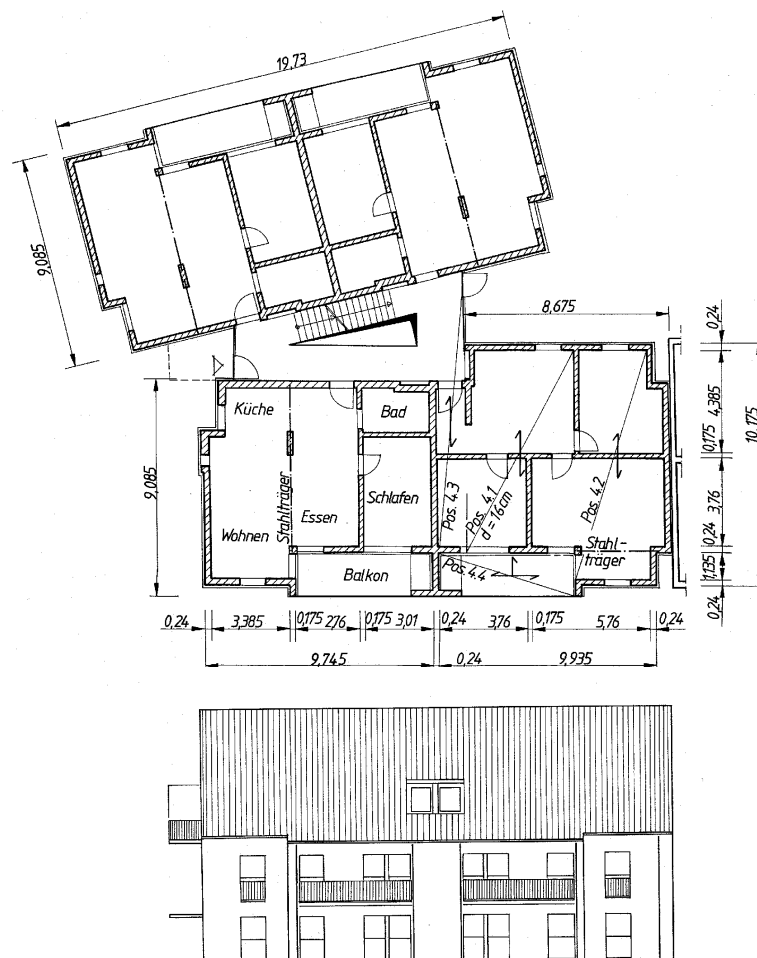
Grundriss und Ansicht Wohnhaus Samlandweg
